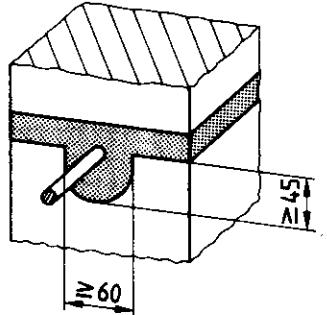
Horizontale Bewehrung in Formsteinen (Prinzipskizze)
